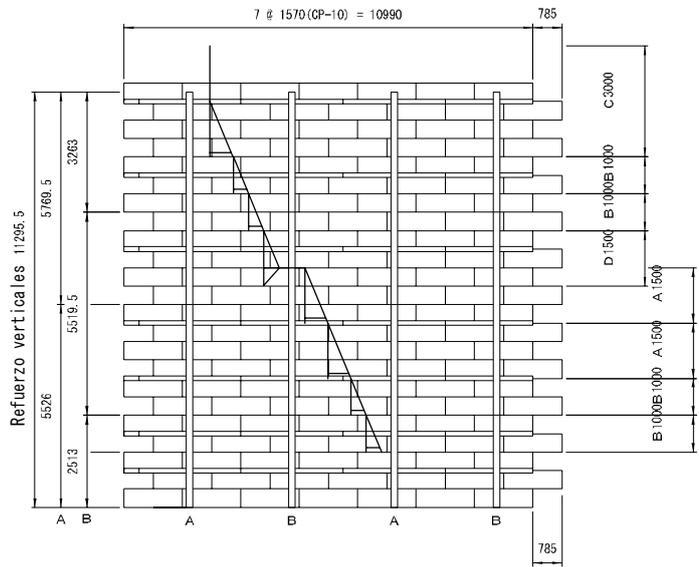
Plano estructural del pozo No.1 (El Reparto)
